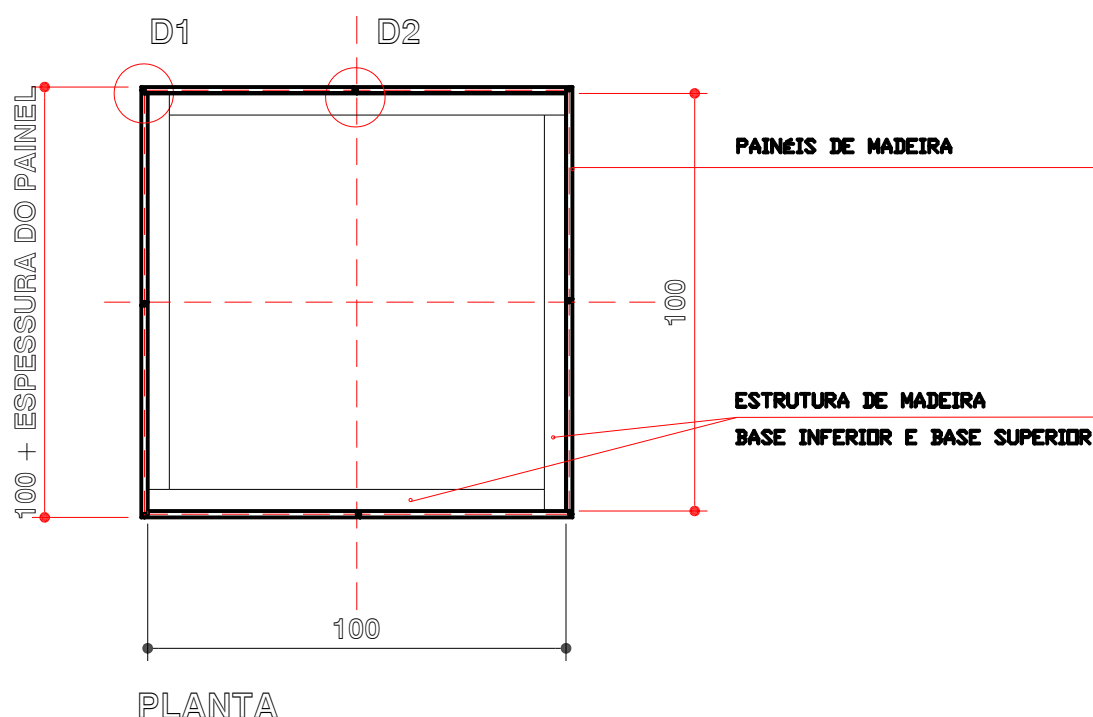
PLANTA DOS PROTÓTIPOS
